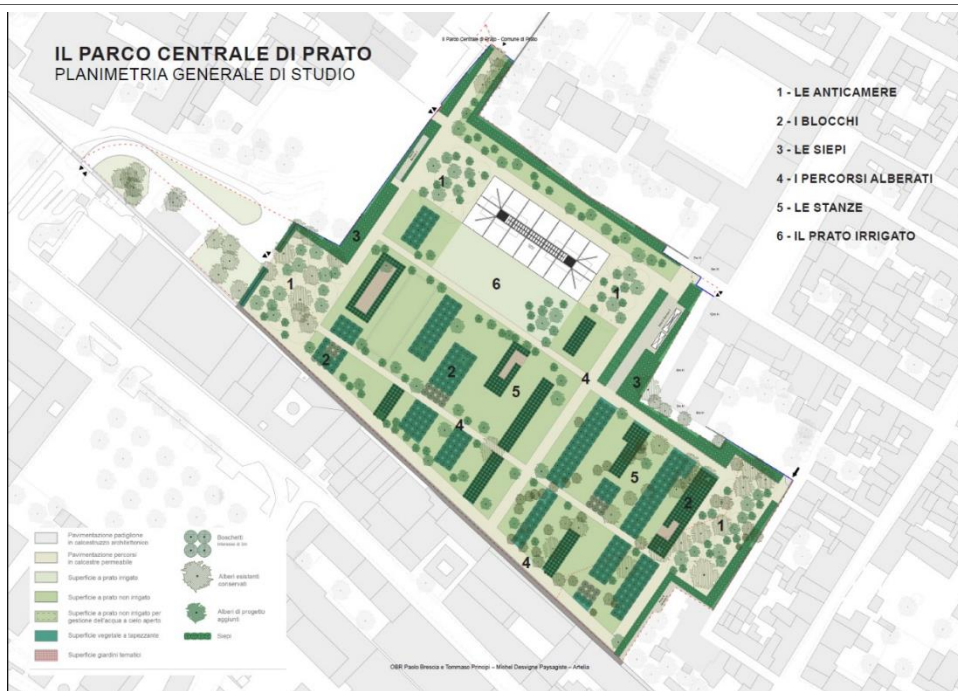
Planimetria generale di studio del Parco Centrale di Prato.
